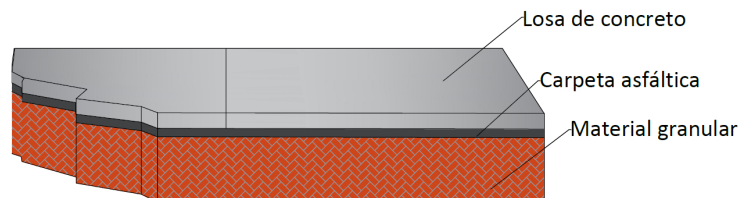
Estructura del pavimento evaluado en el trabajo.
